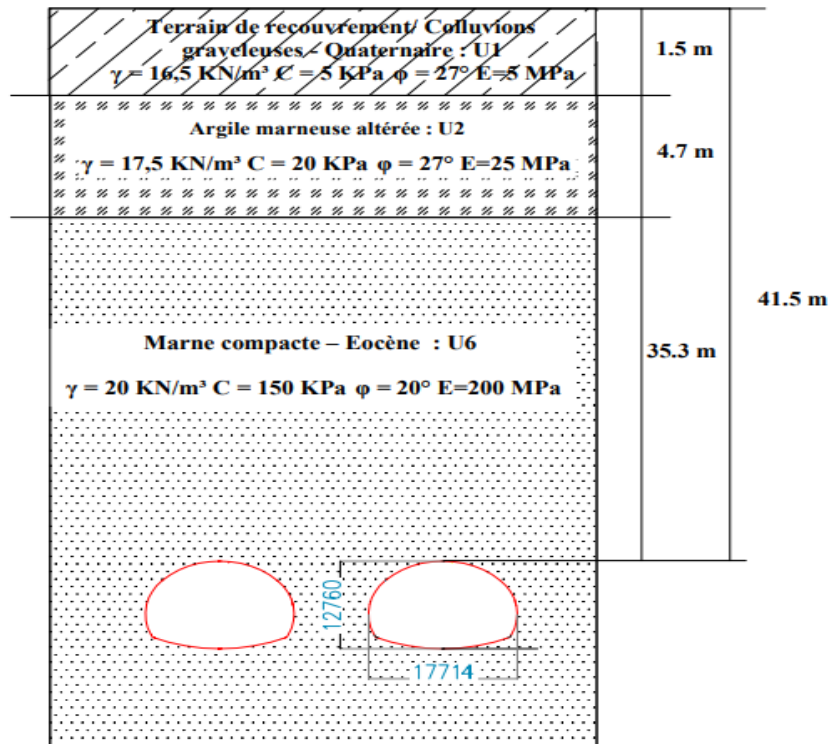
Coupe transversale de tunnel avec les différentes couches au-dessus de Tunnel
